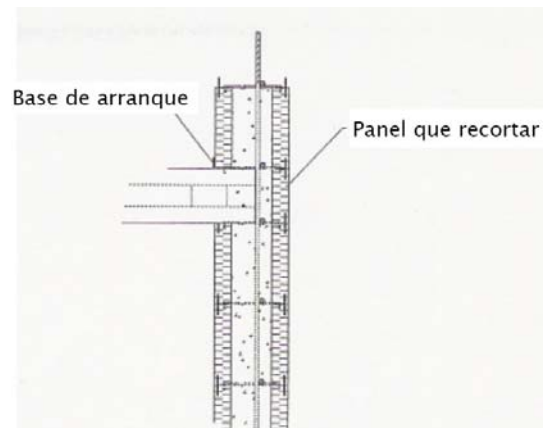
a Alineamiento de los paneles de bordes con la losa de concreto
